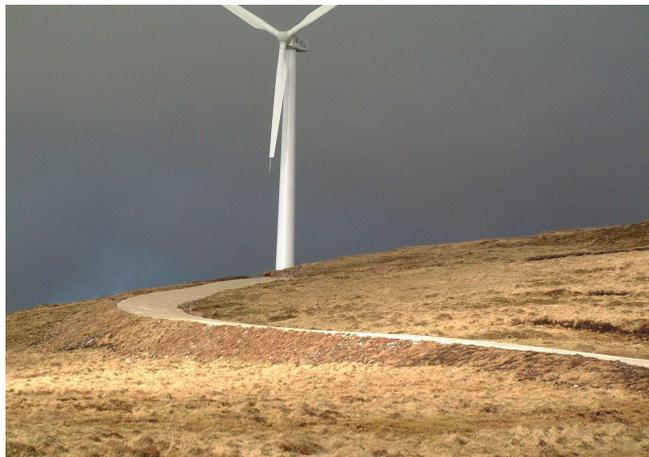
Detalle de pistas adaptadas a la orografía del terreno
